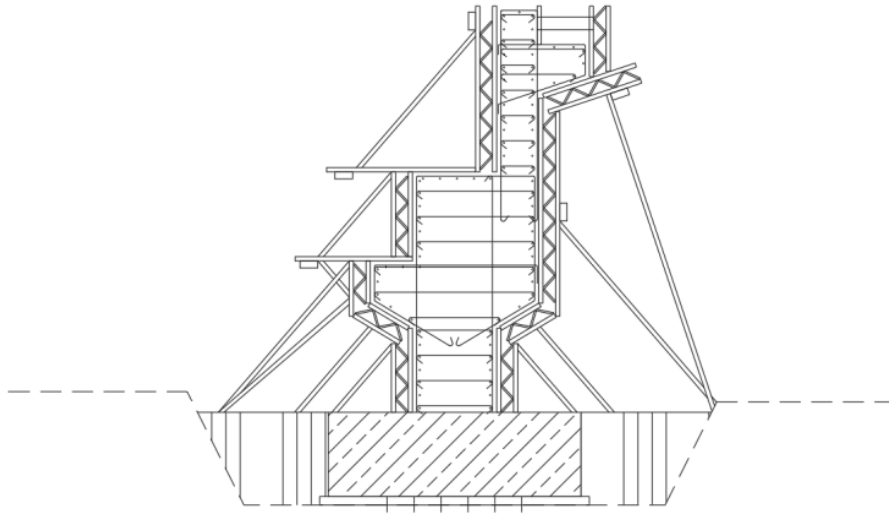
Pekerjaan penulangan badan *abutment
